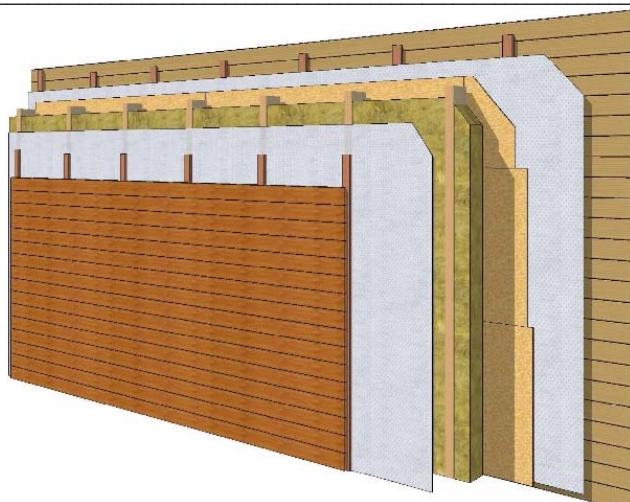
Конструкция наружной стены каркасного дома (вариант 1)
